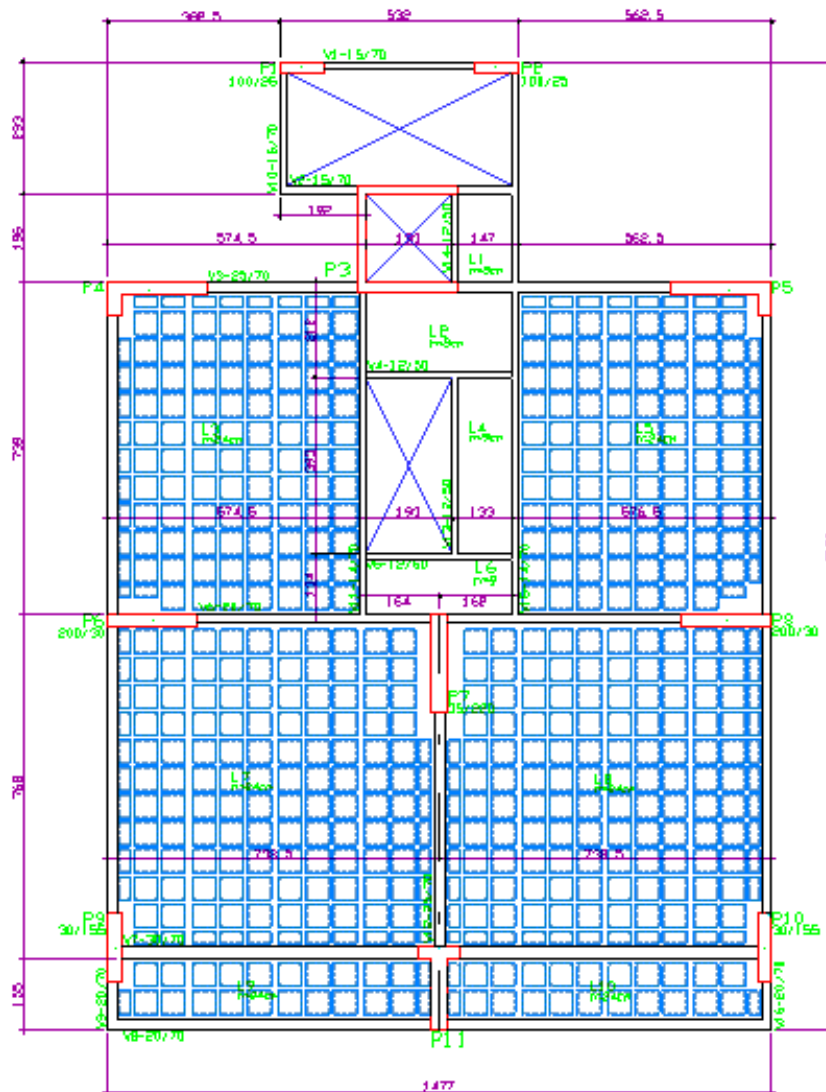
Planta baixa da forma do pavimento-tipo – Edifício 2
